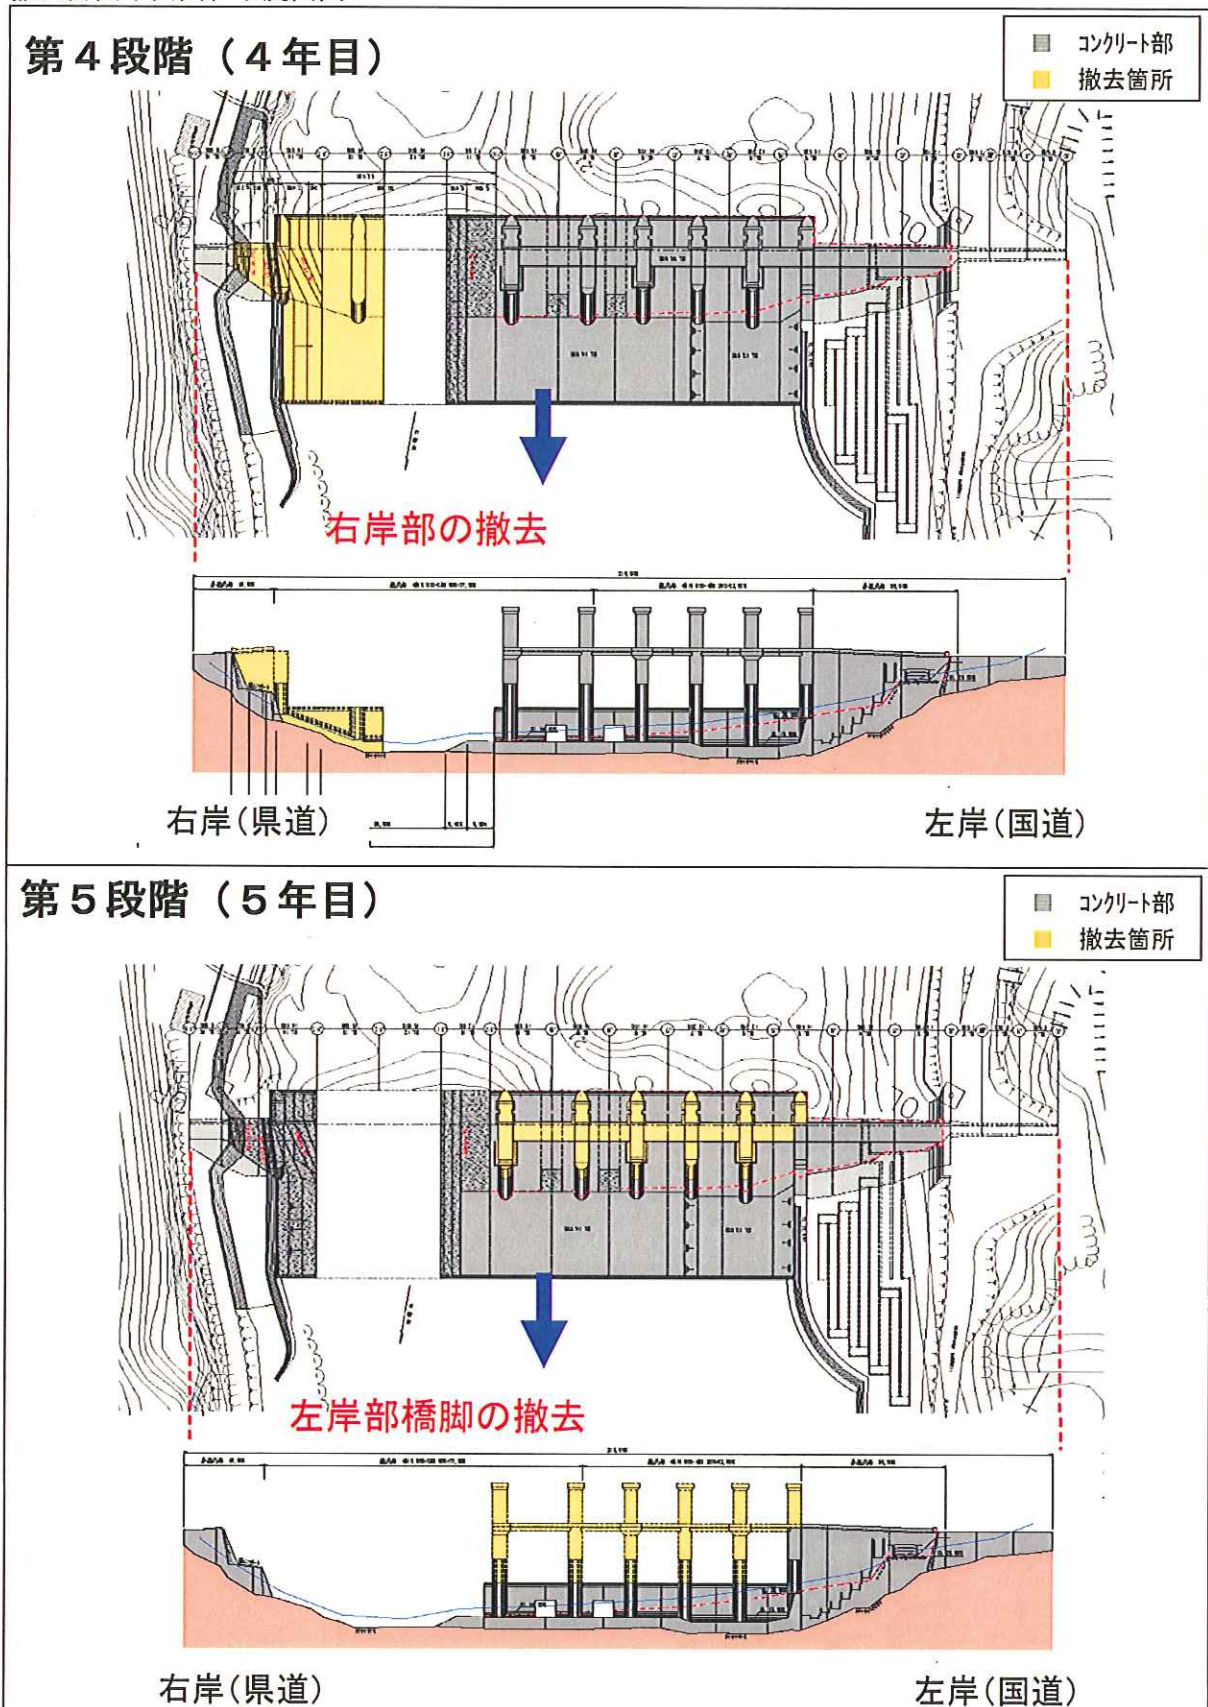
(3) 撤去計画平面図、下流面図 (第4、5段階)
